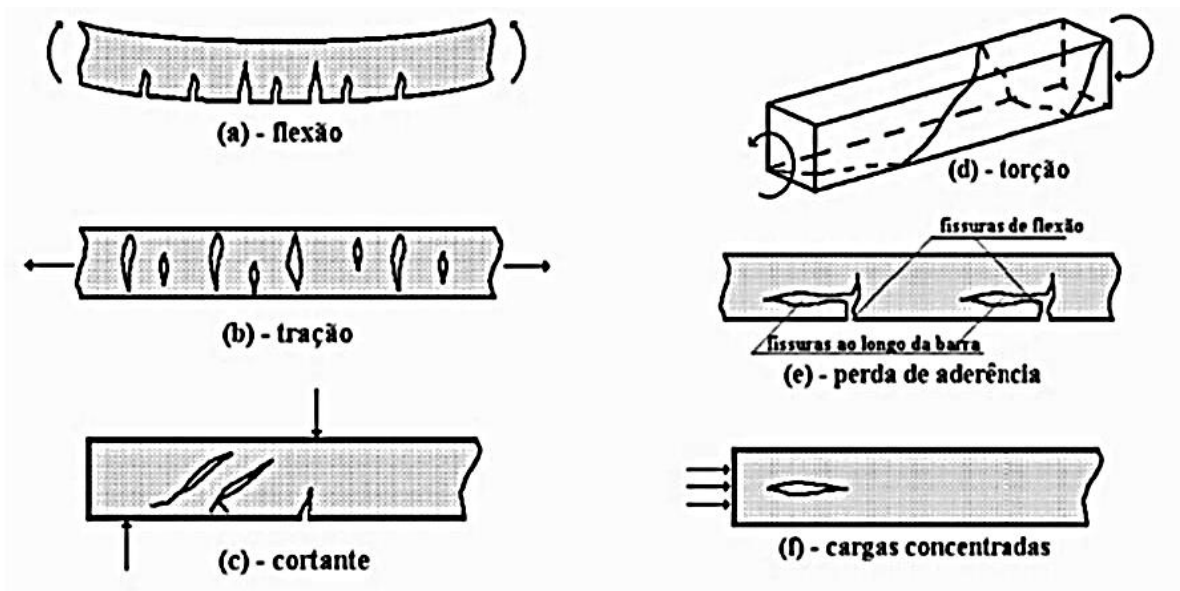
Fissuração por cargas excessivas (Souza,1998)
